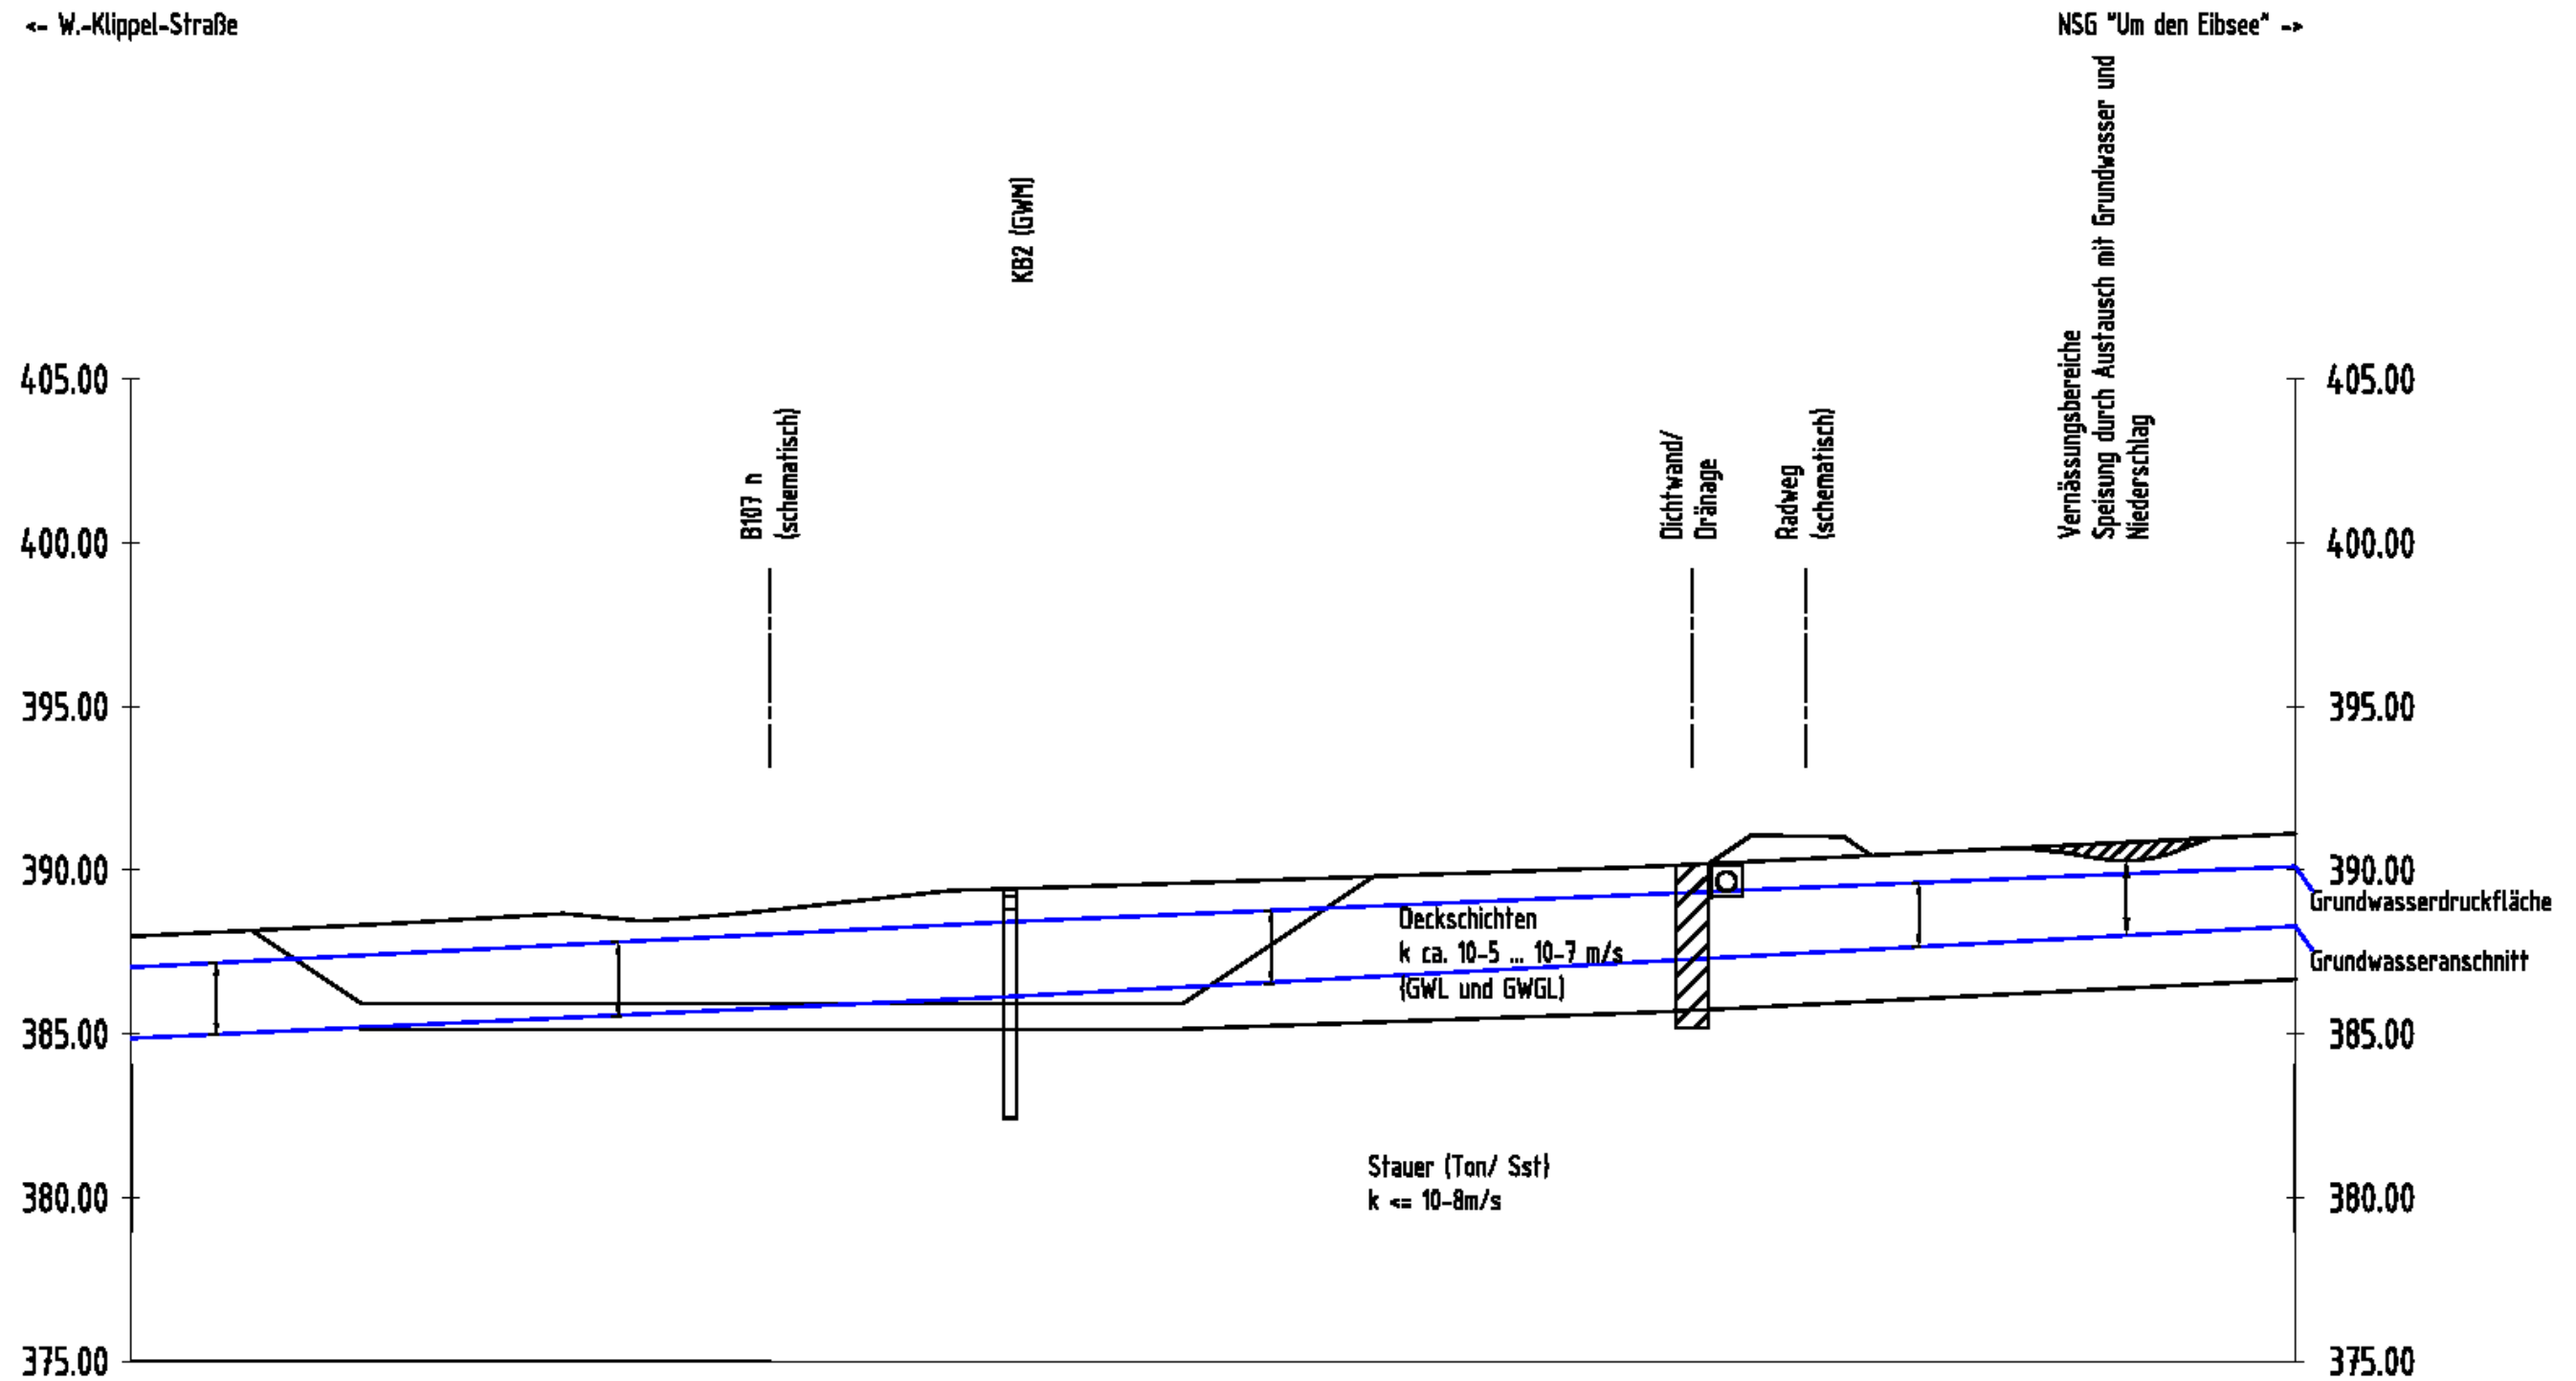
Schematischer Schnitt mit Darstellung Grundwasseranschnitt, Druckfläche und geplanten baulichen Einrichtungen, ca. Bau-km 0+825
